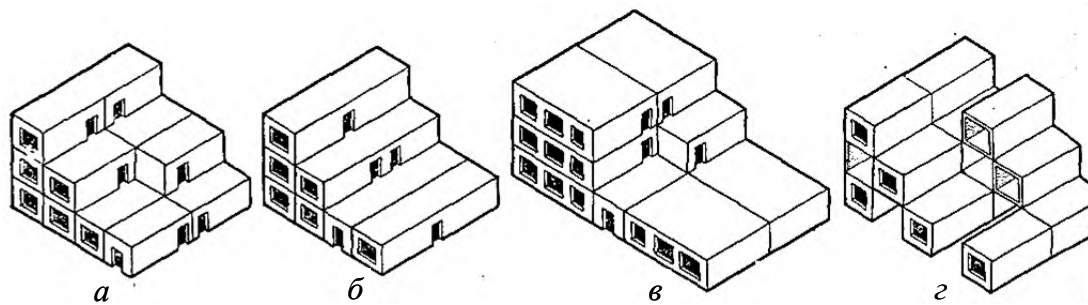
Здания из объемных элементов блочной и панельно-блочной схем:
